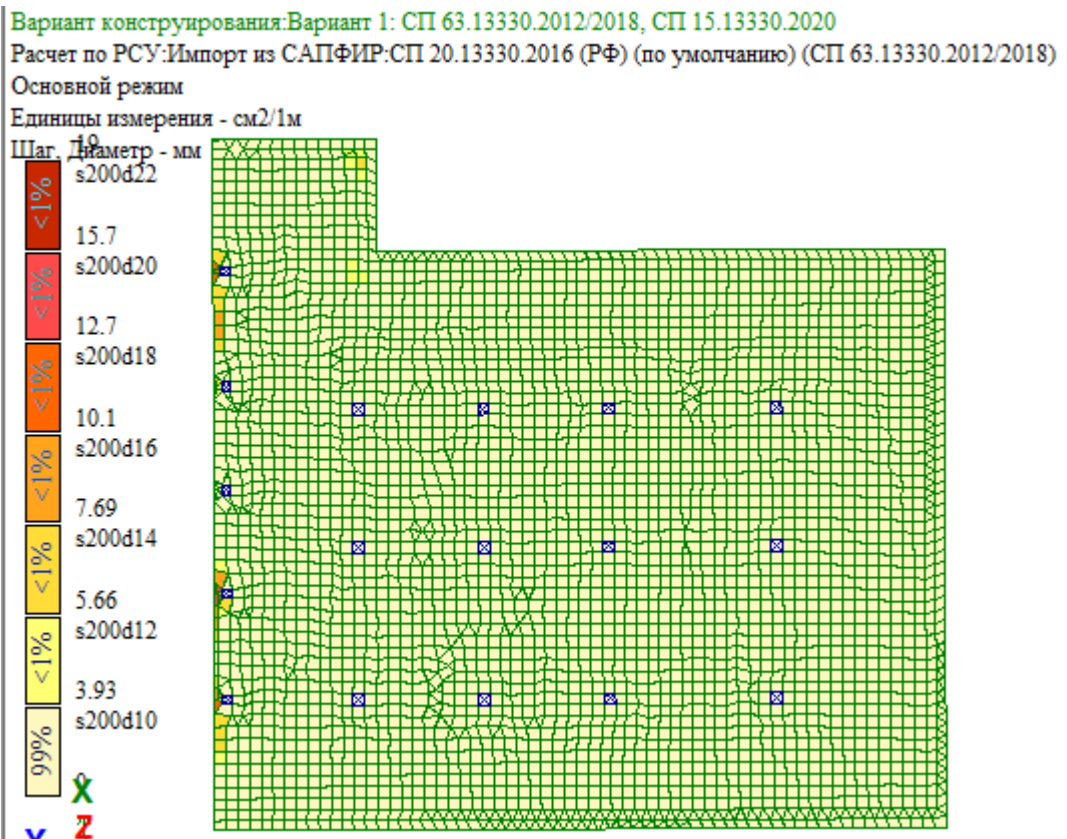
Схема армирования низа плит по оси ОУ
